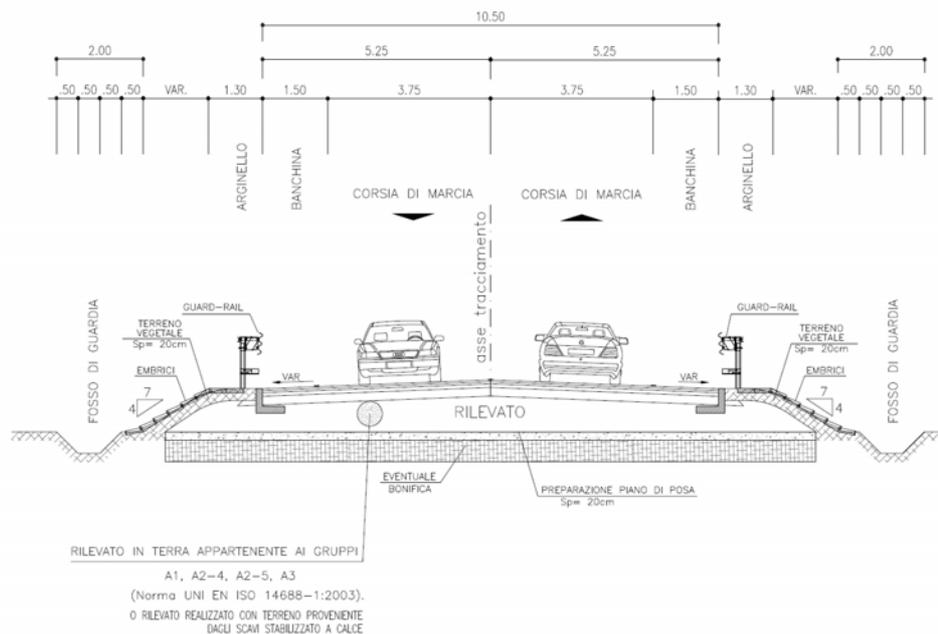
Sezione tipo rampa bidirezionale in rilevato
